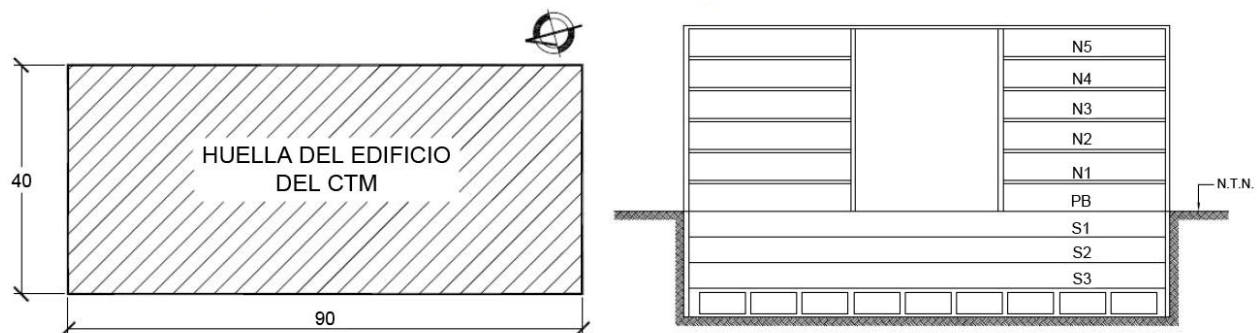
Planta y corte longitudinal del Edificio de la CTM.
